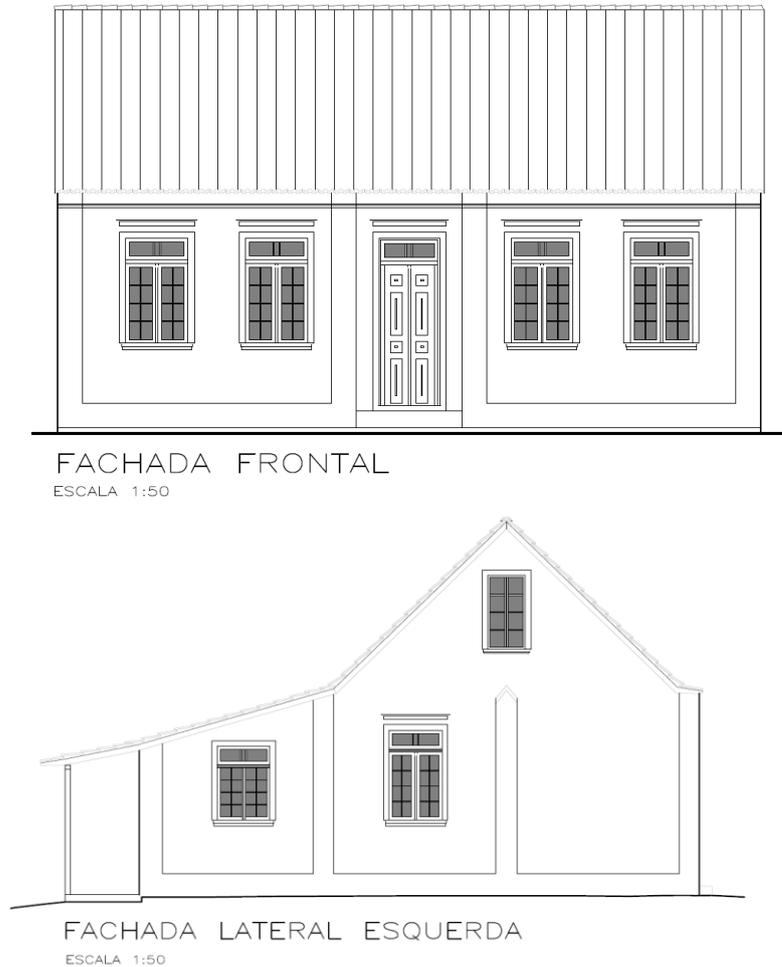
ELEVAÇÕES DA CASA DE ALVENARIA
